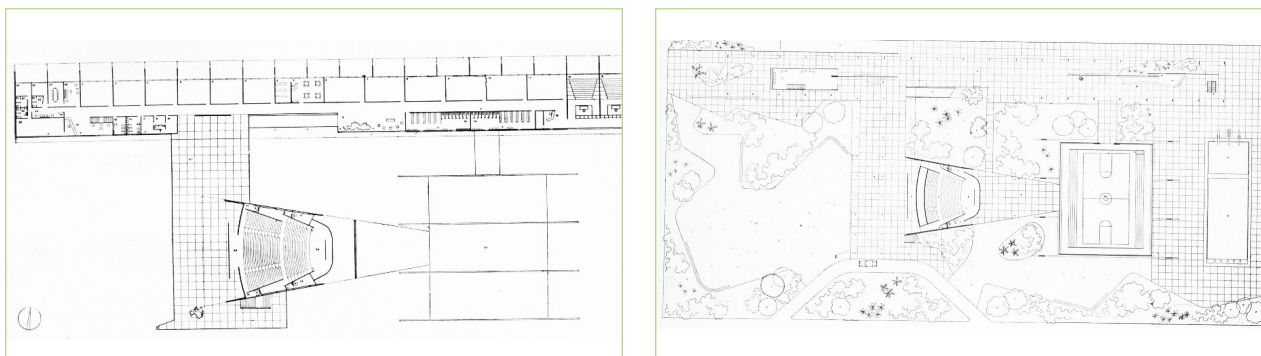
Planta do primeiro piso: observa-se que as salas são posicionadas na face oposta da área de vivência; afastadas da entrada, do ginásio e do parque aquático.
